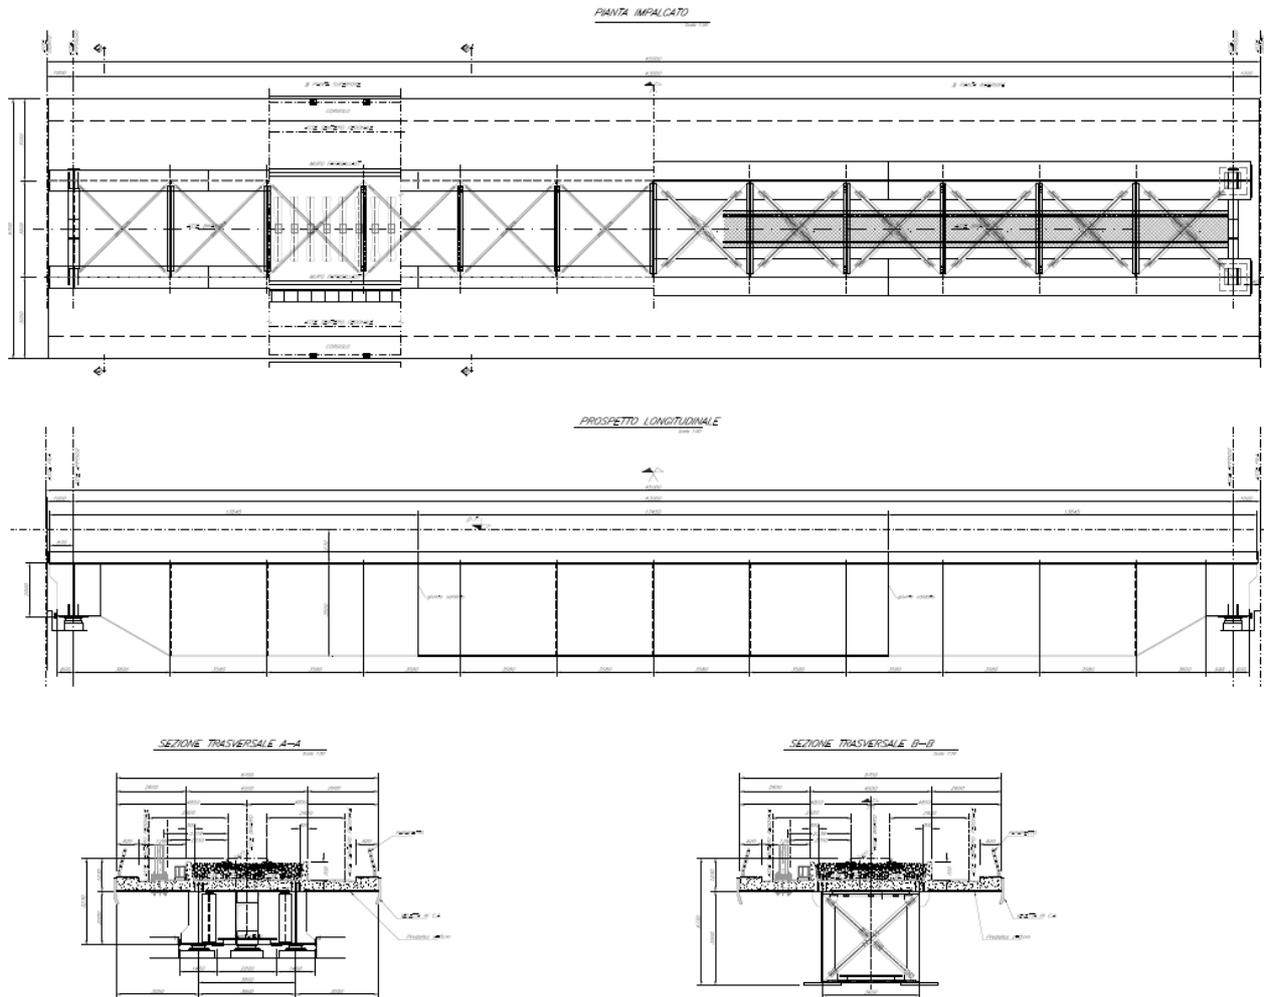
Planimetria del viadotto ferroviario VI02b (il VI01a è la WBS che ripercorre il viadotto esistente)
